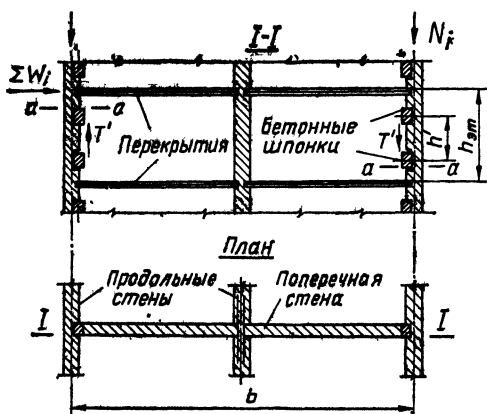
Перевязка поперечных и продольных стен бетонными шпонками.
